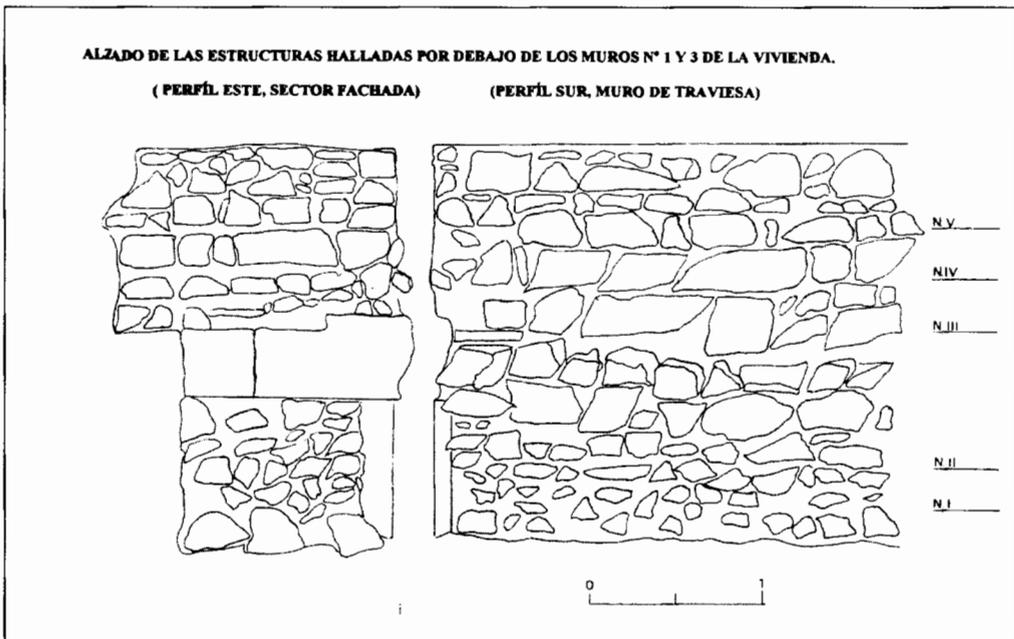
Sector A de la cata arqueológica. Alzado correspondiente a los muros sur y este documentados por debajo del pavimento augusteo.
